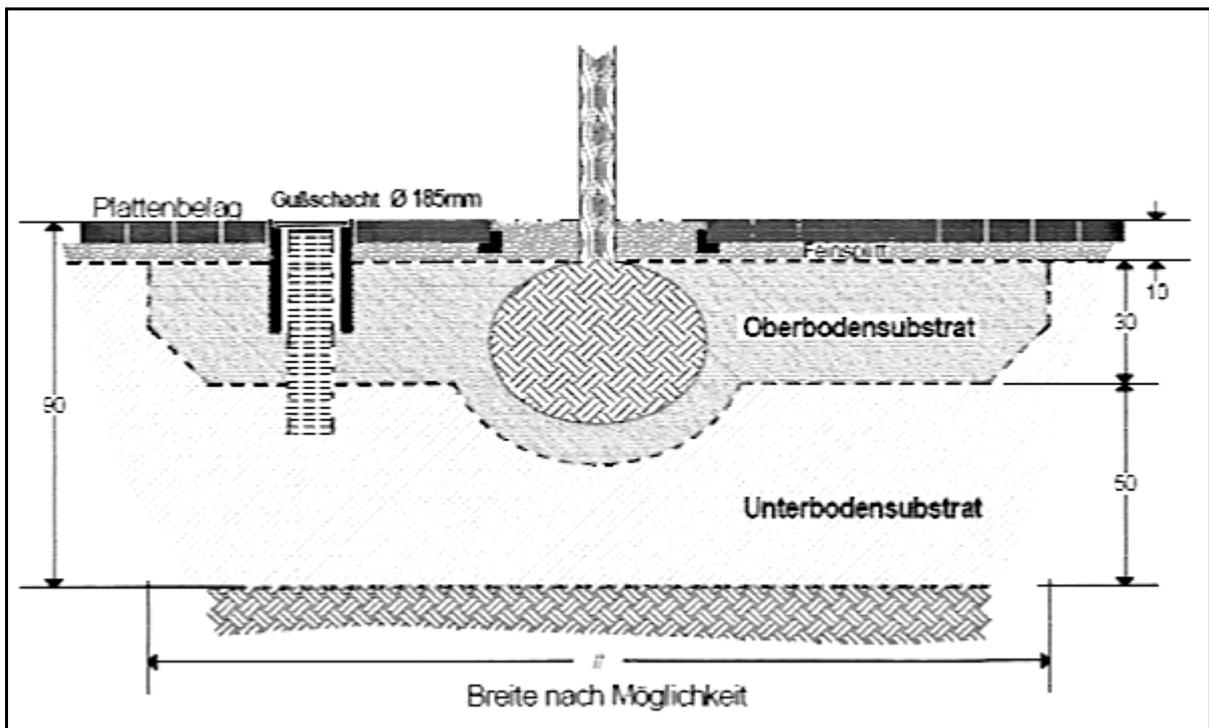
Richtlinie der Wiener Stadtgärten für eine Baumscheibe mit Pflasterdecke und Gulsschacht
